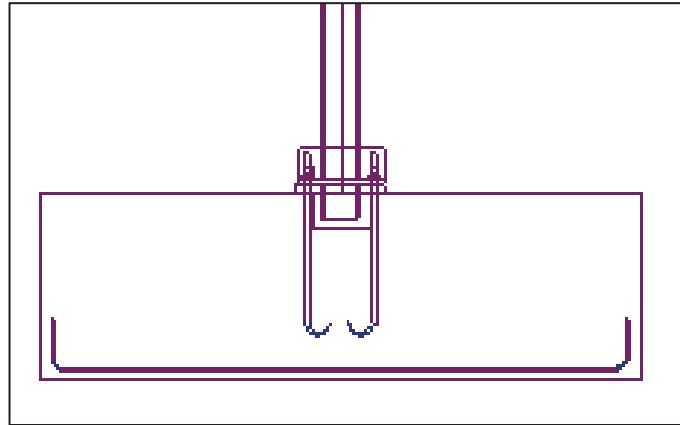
Detalle de las zapatas de los pórticos tipo de los bloques de cebo 1 y 2.
